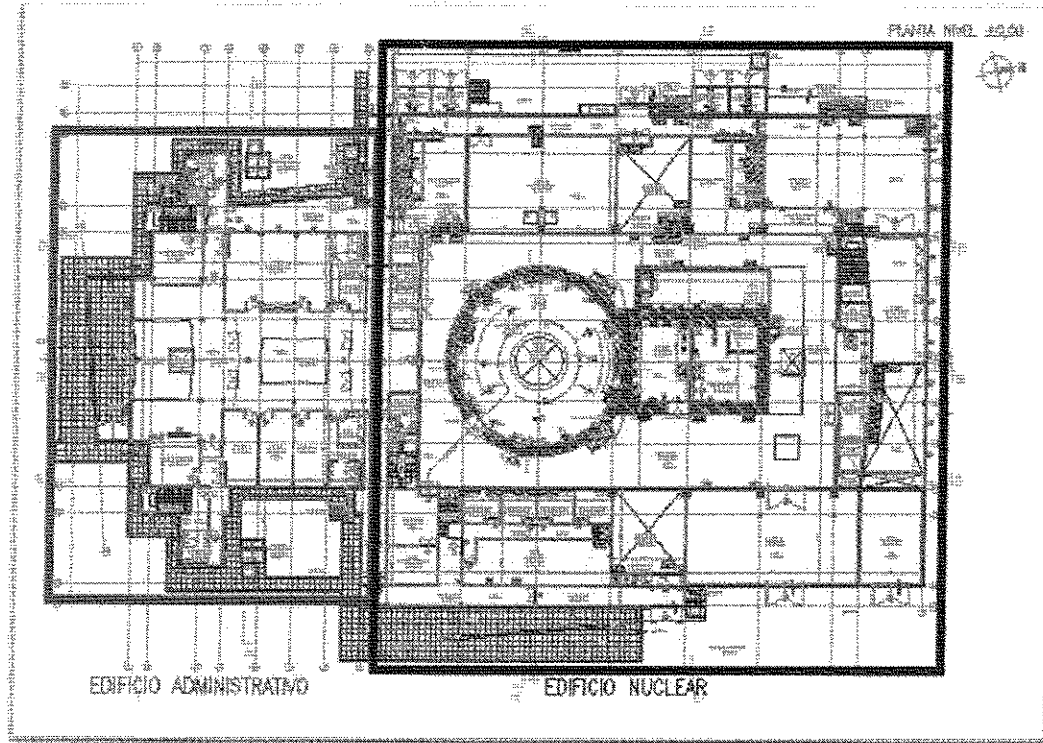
Zonificación del Edificio en planta Nivel +/- 0,00 m.
